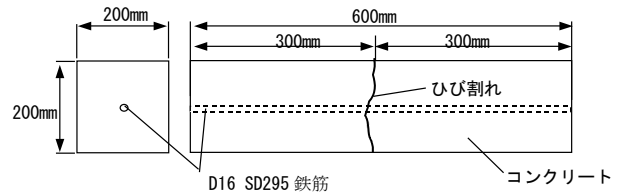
試験体の形状・寸法とひび割れ導入位置
